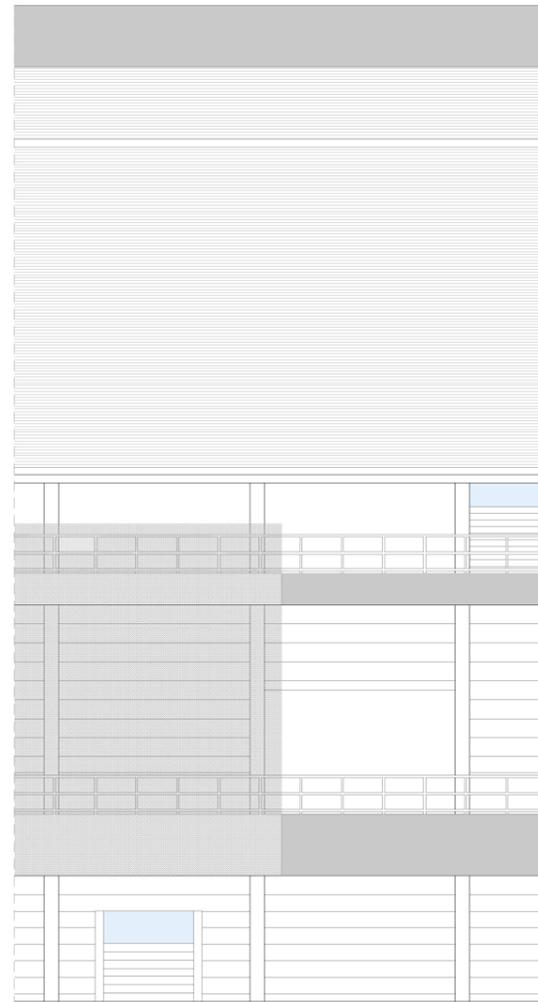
Alzado de la fachada general del edificio, donde se aprecia la composición del mismo. Elaboración propia.
